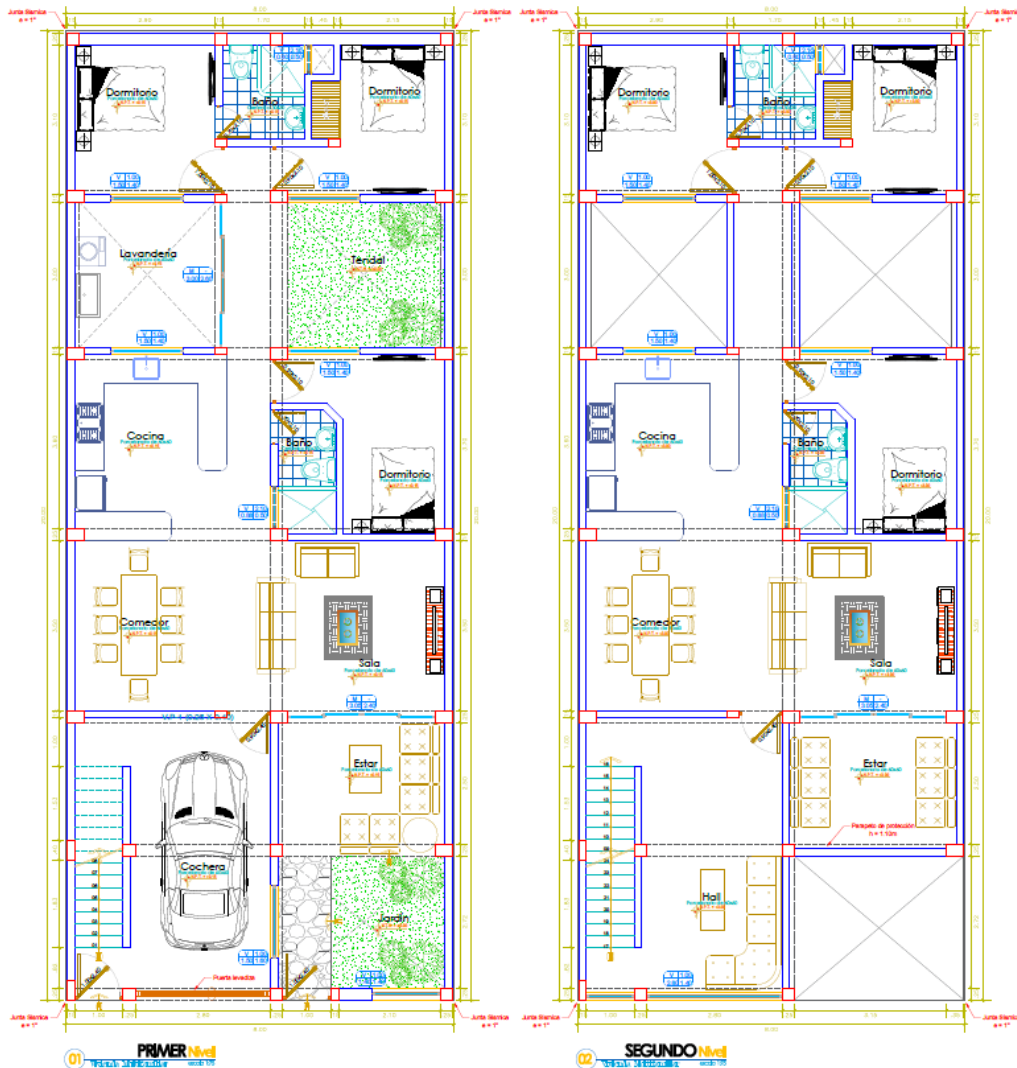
Plano de Arquitectura, primera y segunda planta (Fuente: Propia), ver anexo N° 14
